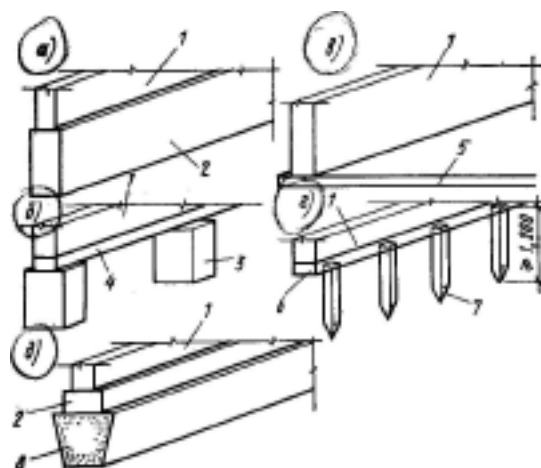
Рис. IV.О Конструктивные схемы фундаментов мвьяэтажных жилых зданий:
